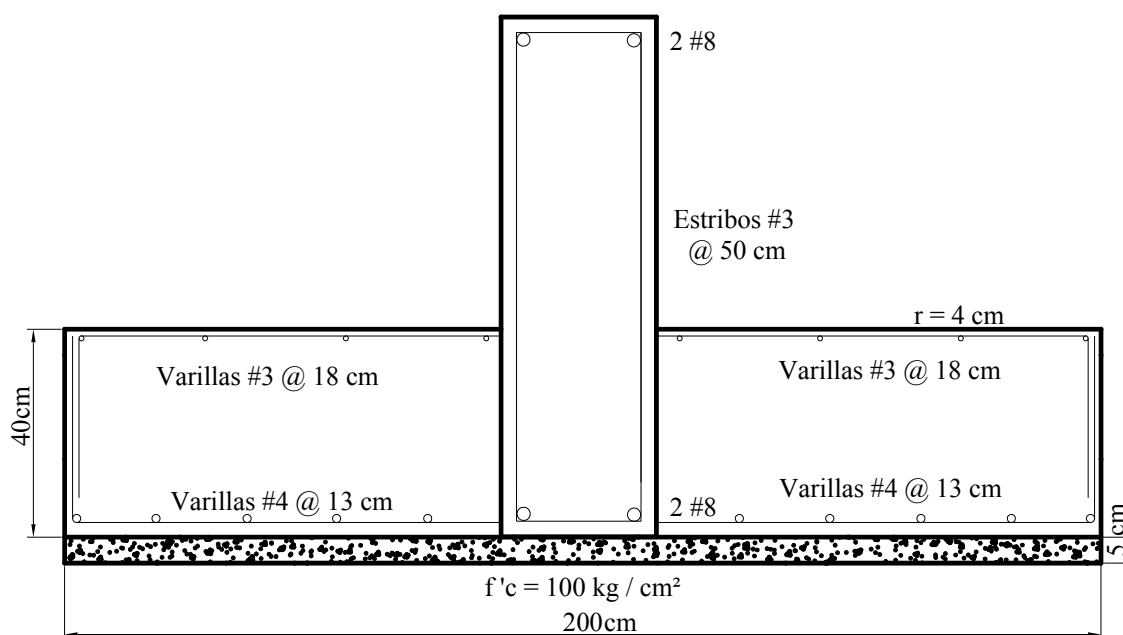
Diseño estructural de la losa y contratrabe de la zapata, caso 3.
